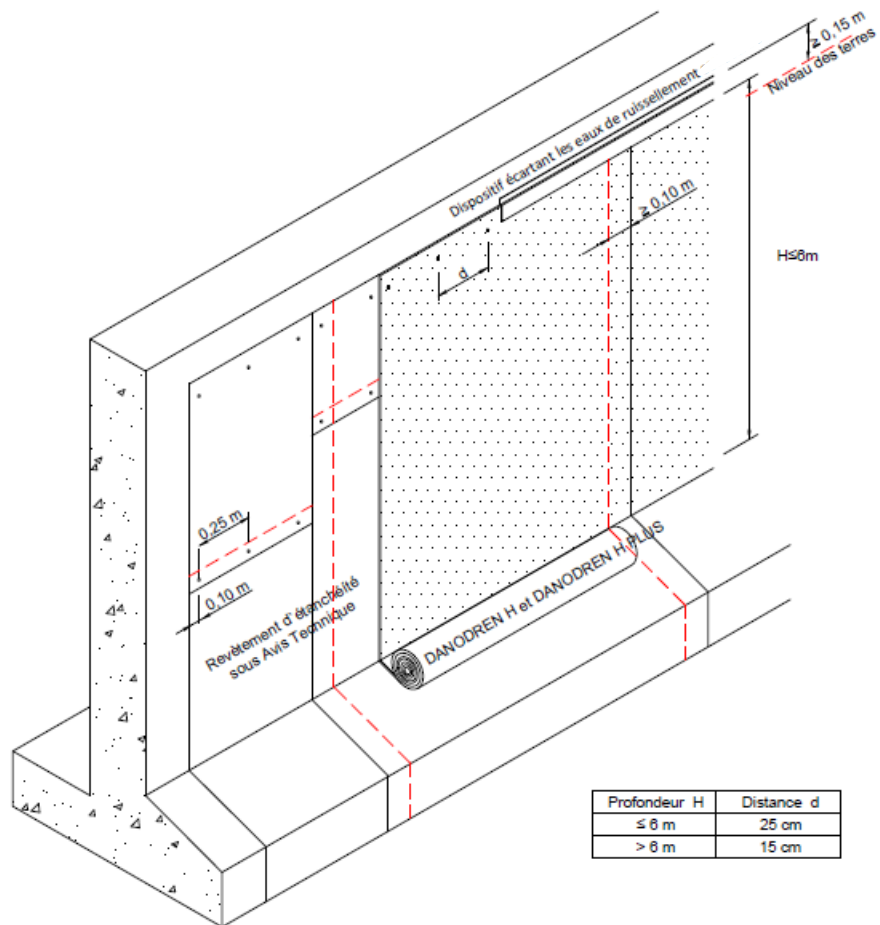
Schéma de principe avec revêtement d'étanchéité (sens de pose vertical)
